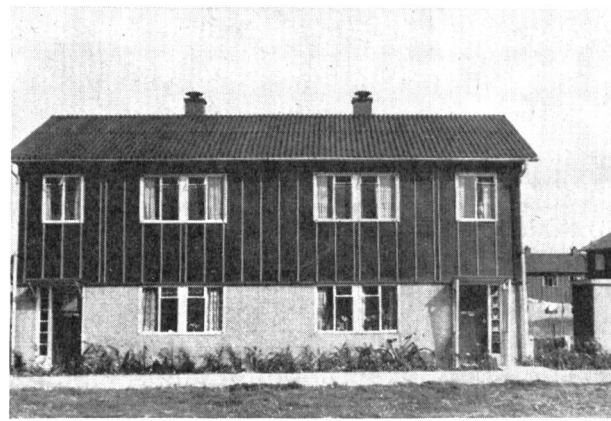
Typisches englisches Einfamilienhaus, dessen Grundriss in Tausend und aber Tausend Exemplaren unverändert auftritt.
